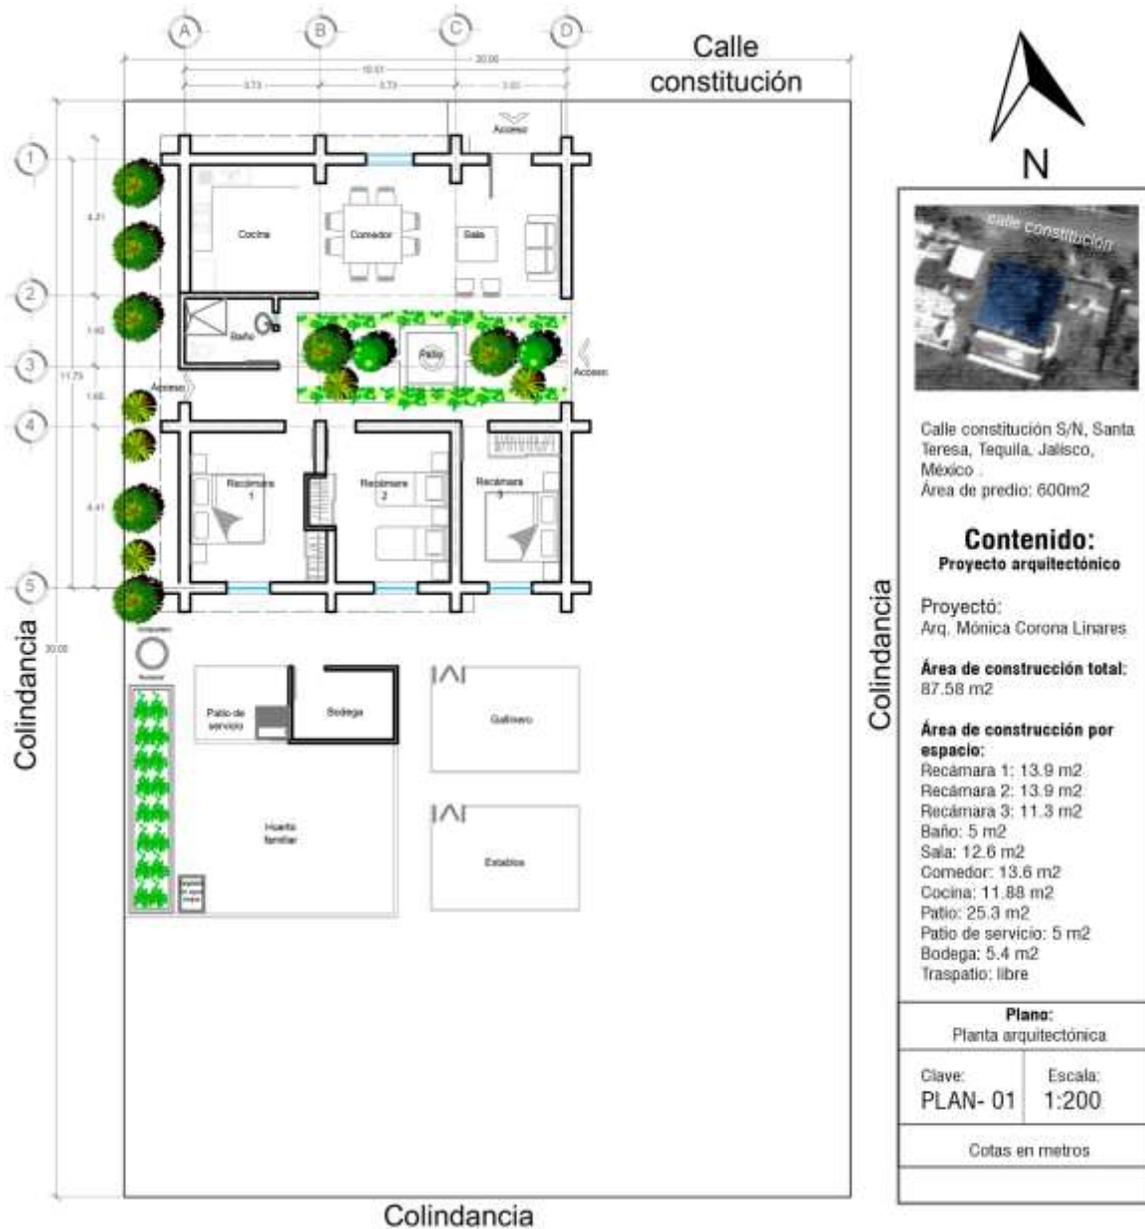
Planta arquitectónica de la vivienda y el traspatio. Fuente: Autor.
